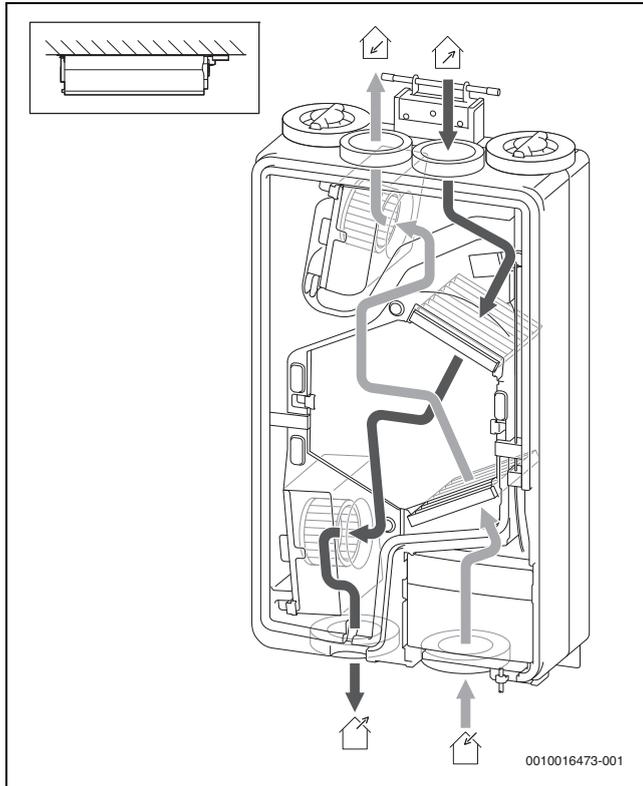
Collegamento dell'apparecchio lato aria per installazione a soffitto
